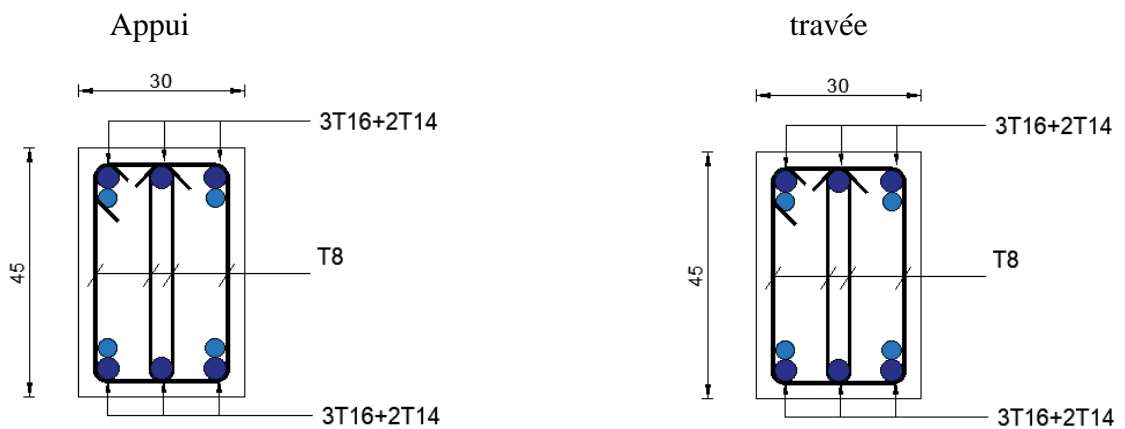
schéma de ferrailages des poutres principales 2 (8^{ème} étage---RDC)
